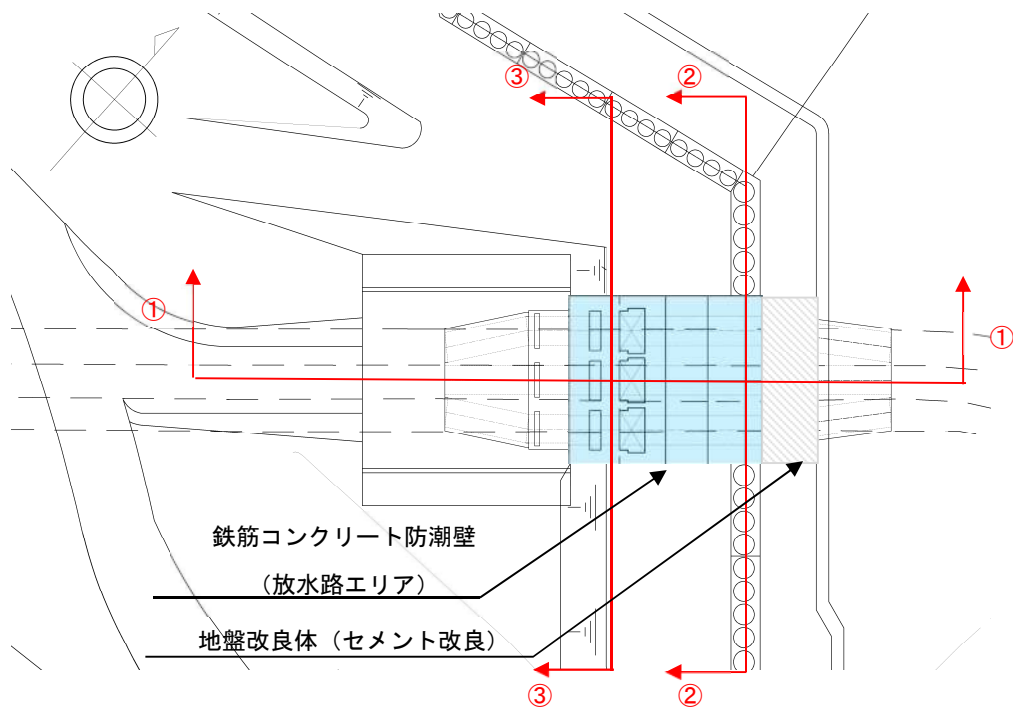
鉄筋コンクリート防潮壁（放水路エリア）の平面図
